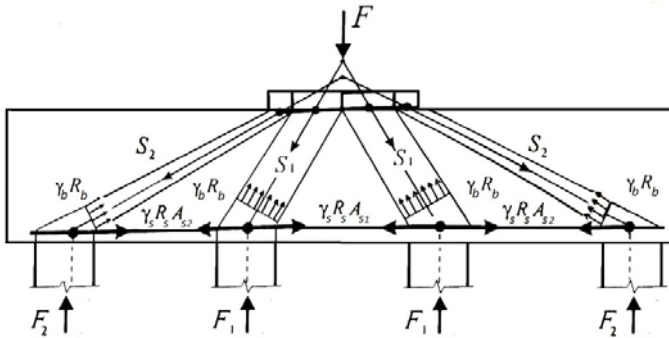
Схема предельных усилий в расчетных сжатых бетонных полосах и растянутом арматурном поясе (модель ПКСП-А)
